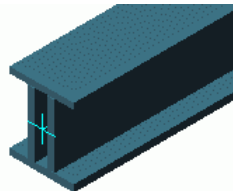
Сварной профиль коробчатого сечения
